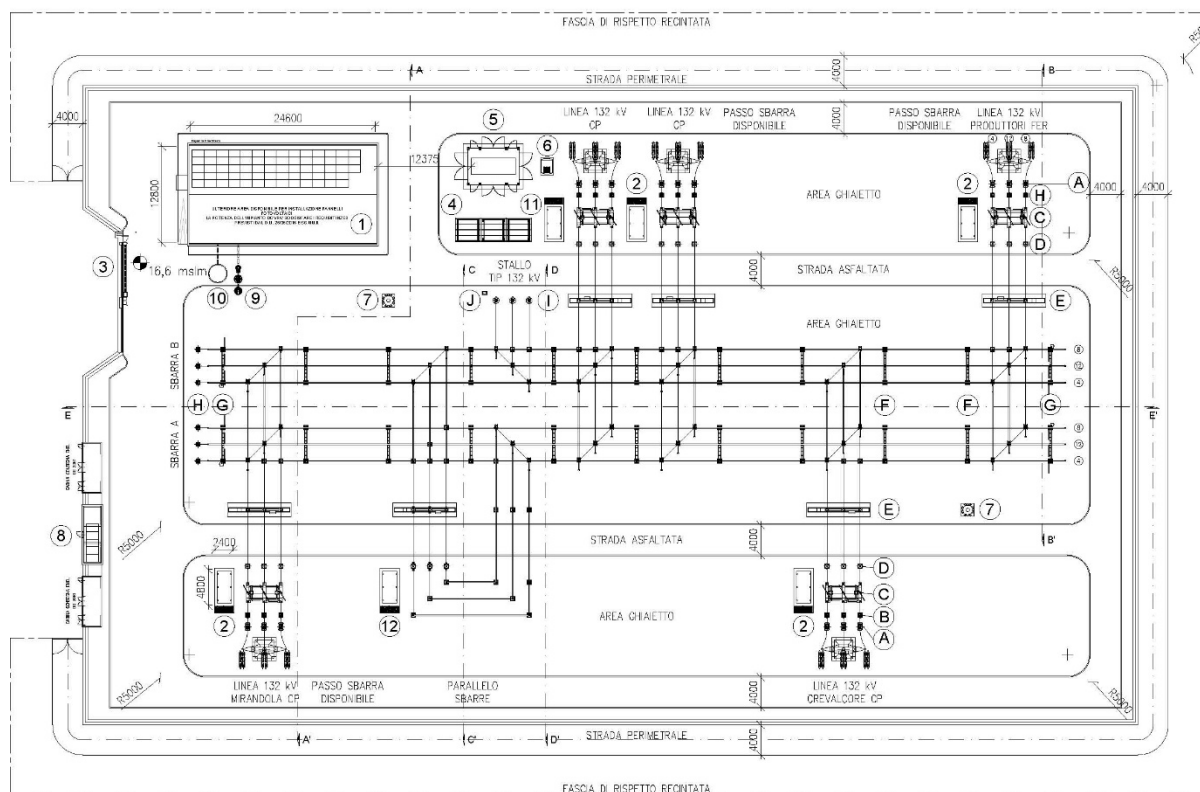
Estratto del documento No.468452 – Planimetria reparto AT
